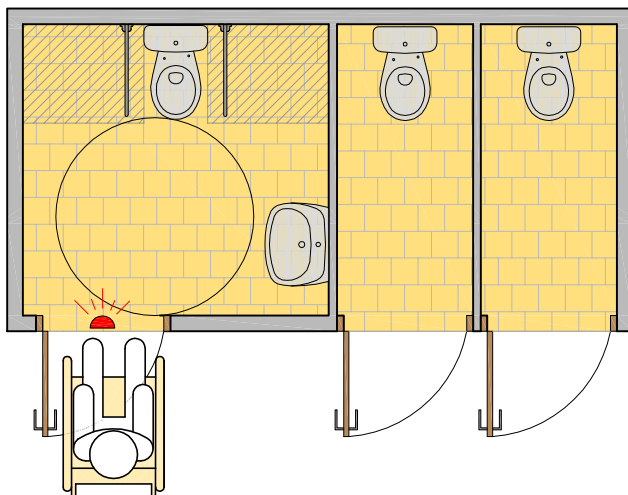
Planta de un aseo de uso público accesible con inodoro y lavabo.
